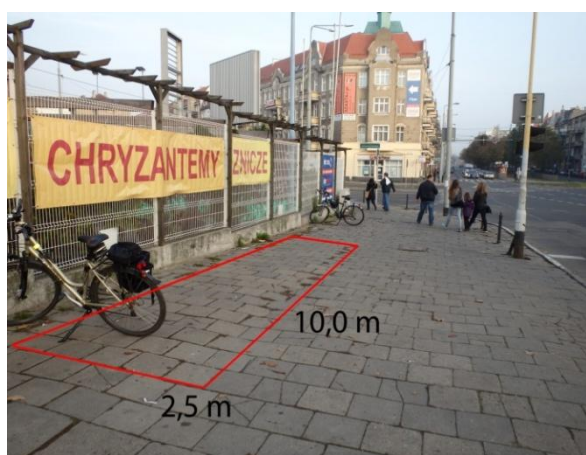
Bike & Ride nr 8 — Plac Grunwaldzki
